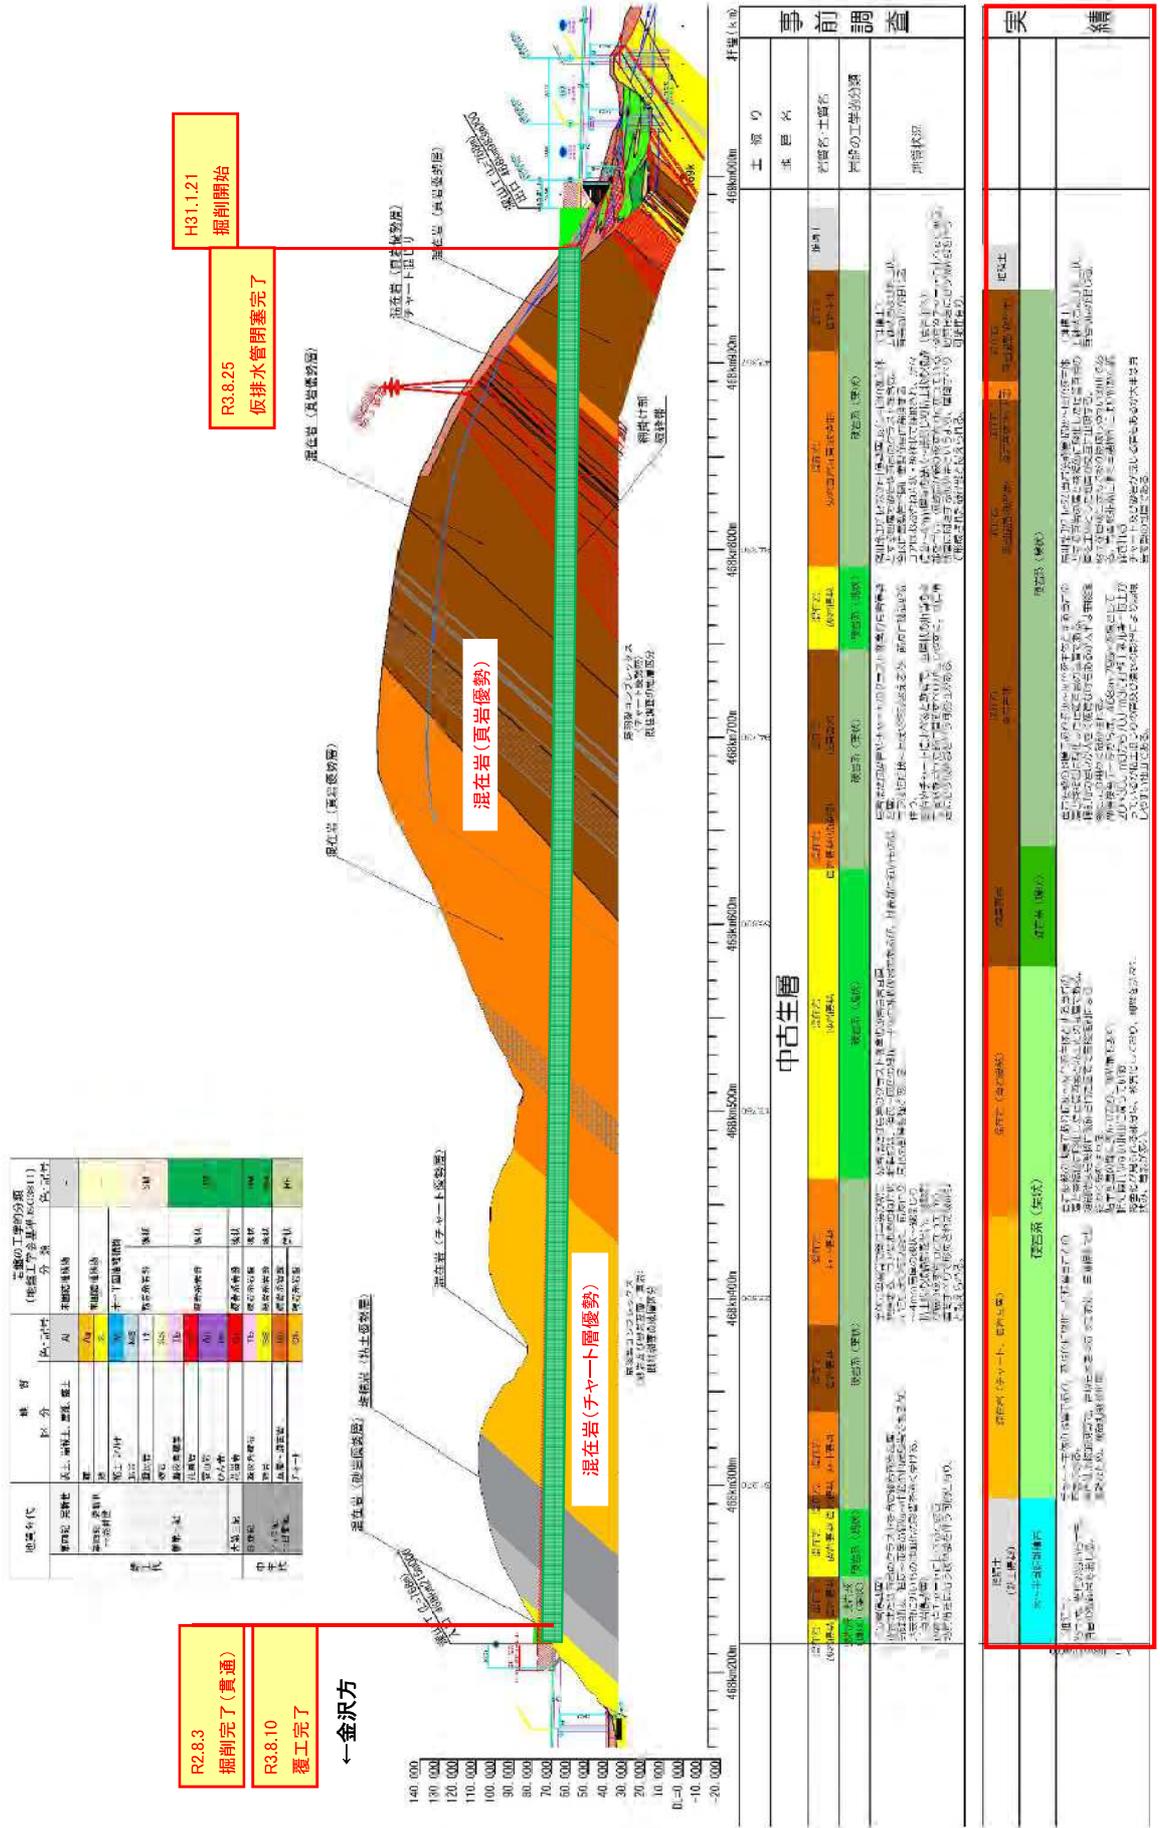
地質縦断面図 (施工後：施工業者による見直し)
